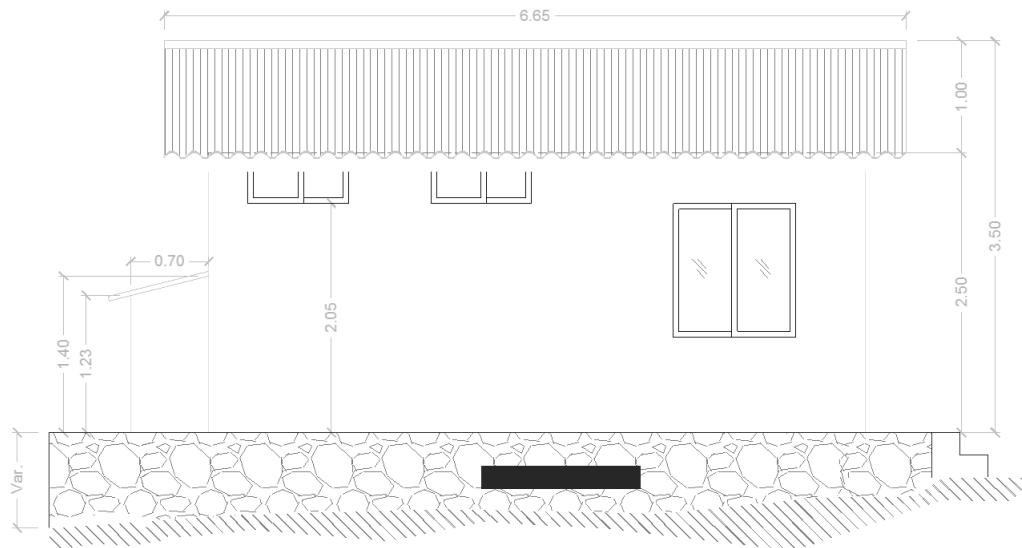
Vista en Elevación y Fachada principal de vivienda económica
